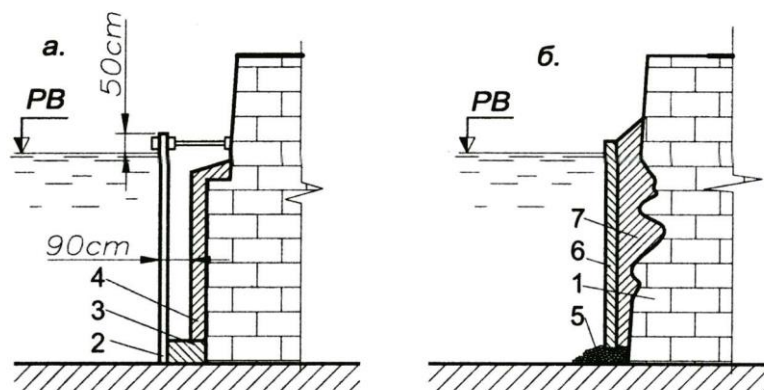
Железобетонная «рубашка» усиления подводной части опор
